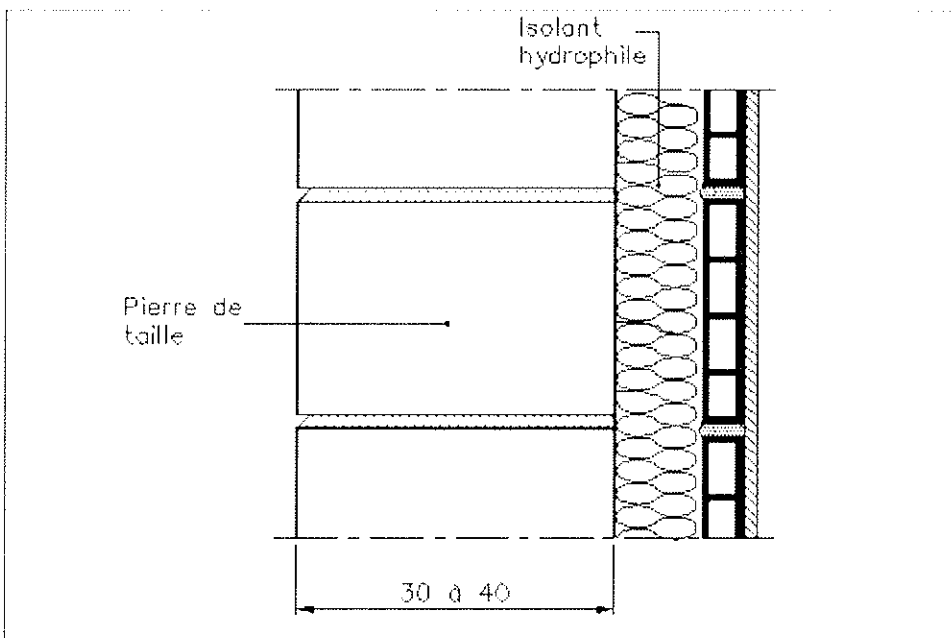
Moellons taillés ou pierre de taille/murs du type IIa/épaisseur minimale de la paroi extérieure en pierre
